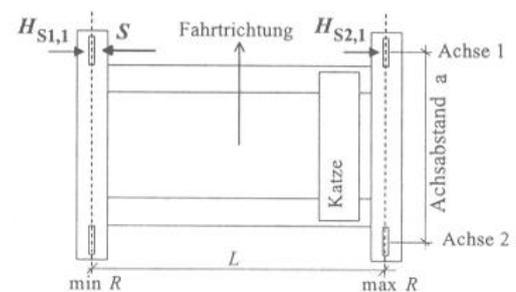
Horizontale Lasten aus Kranbetrieb
